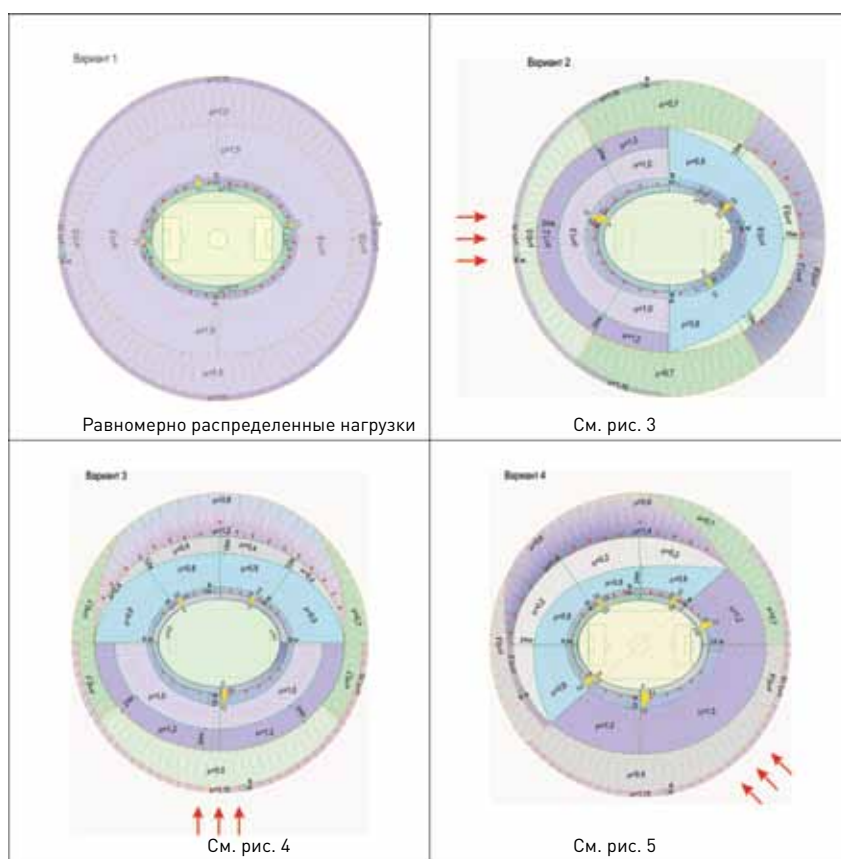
Схемы снеговых нагрузок на покрытие стадиона, полученные по данным проведенных модельных аэродинамических испытаний
